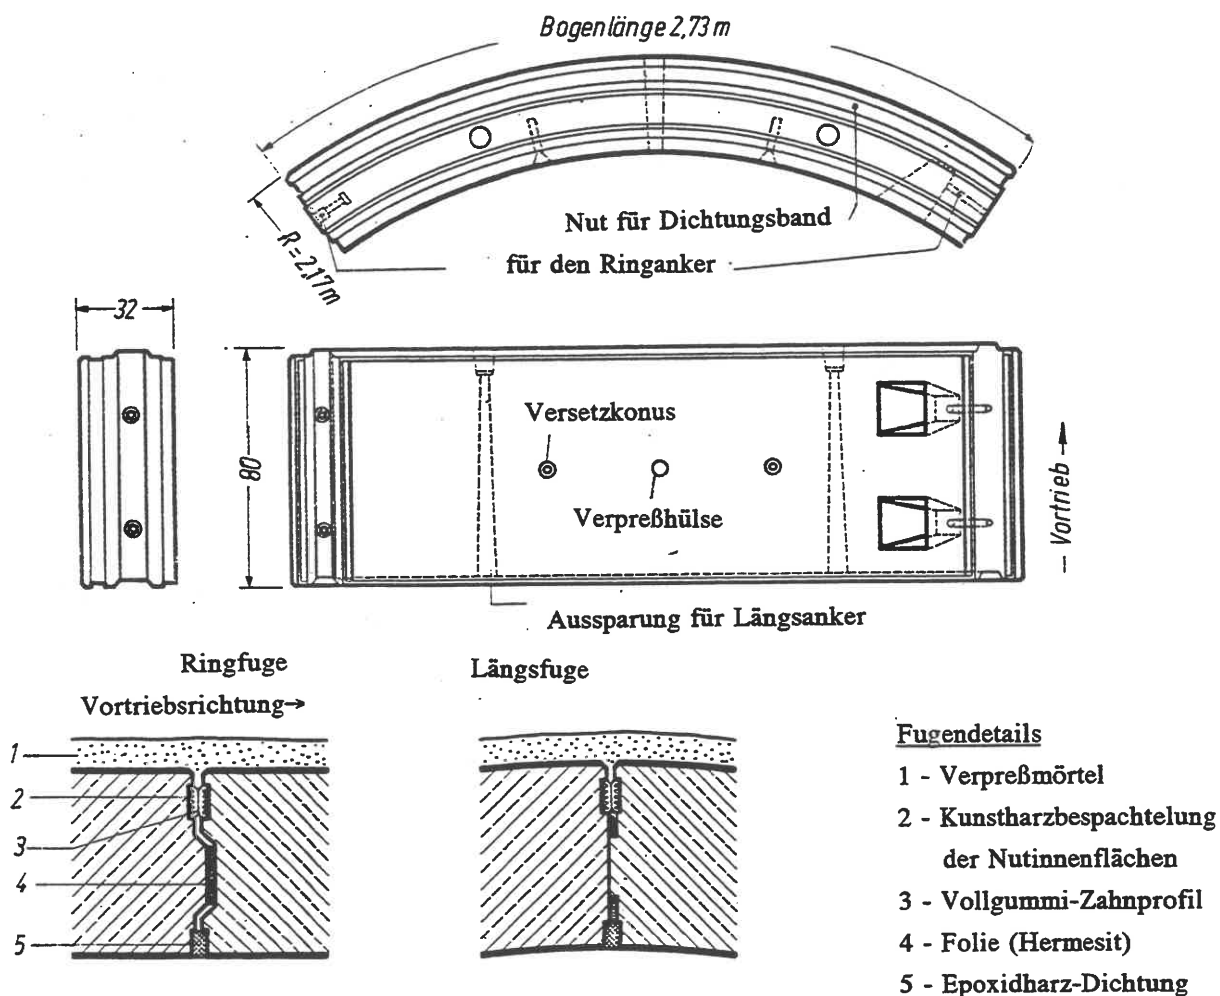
Einschaliger Stahlbeton-Ausbau beim Bau der Münchner U-Bahn
